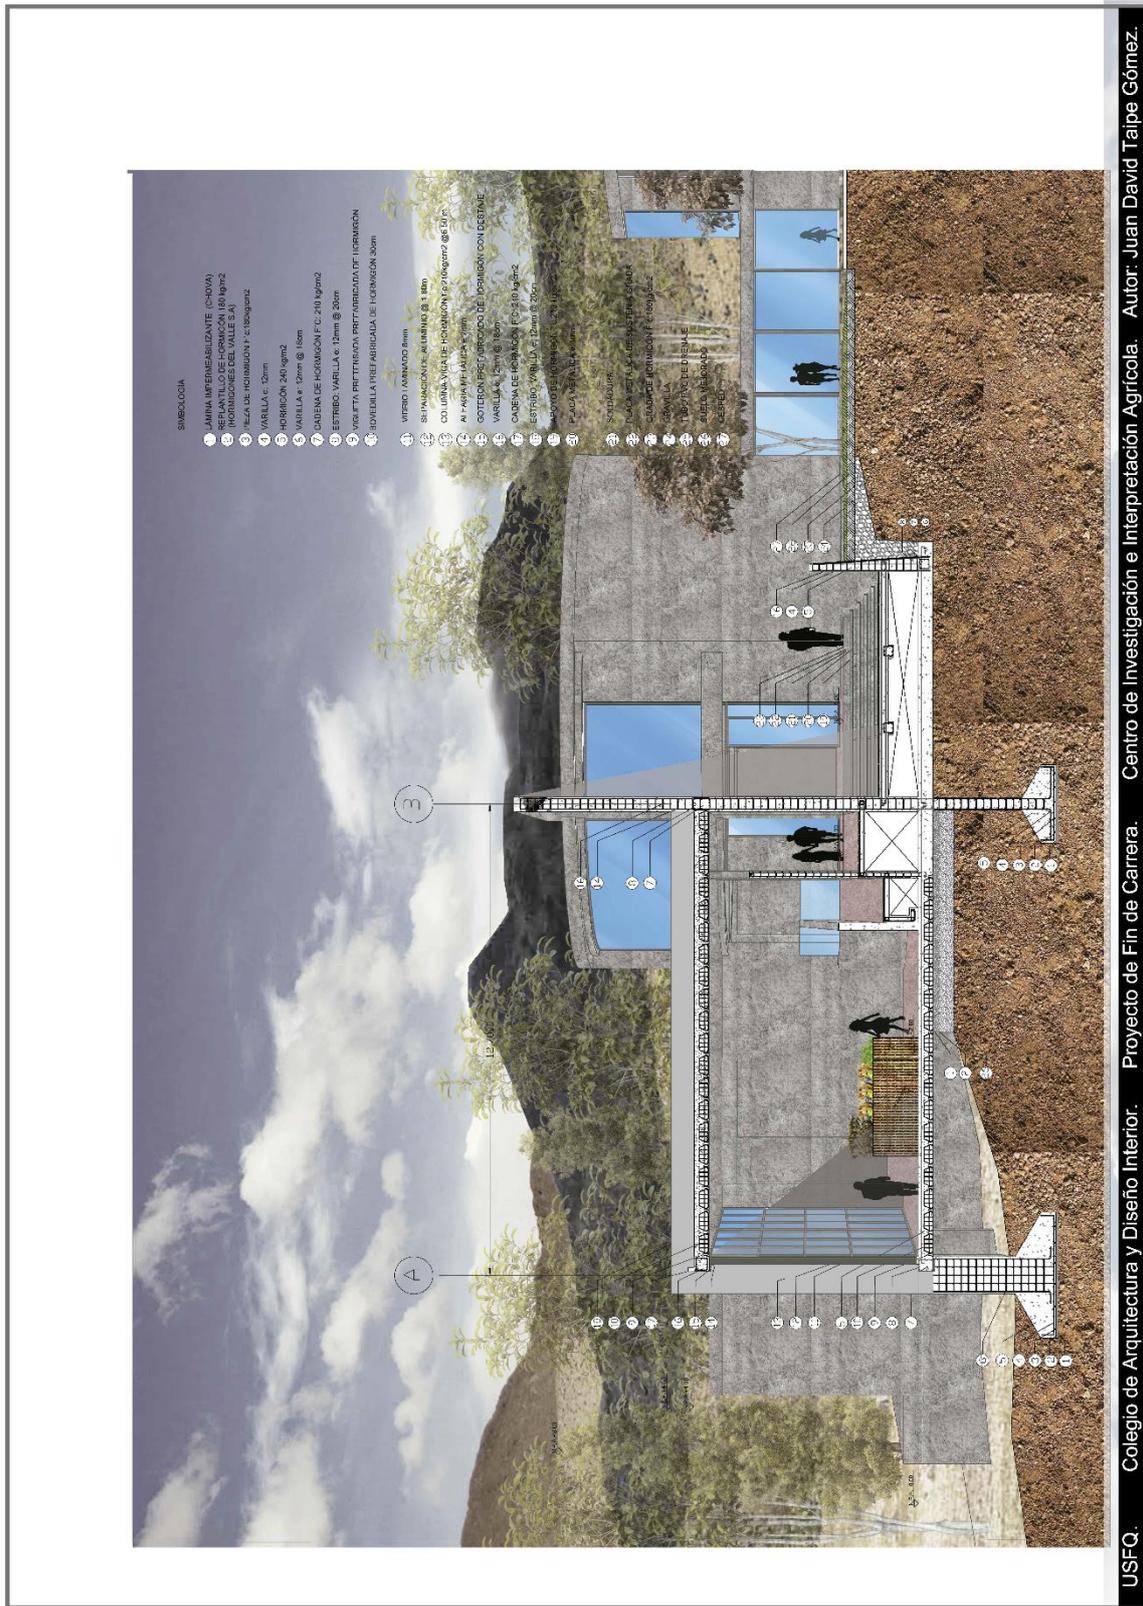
Detalle Constructivo 1 (fuente: elaboración propia)
